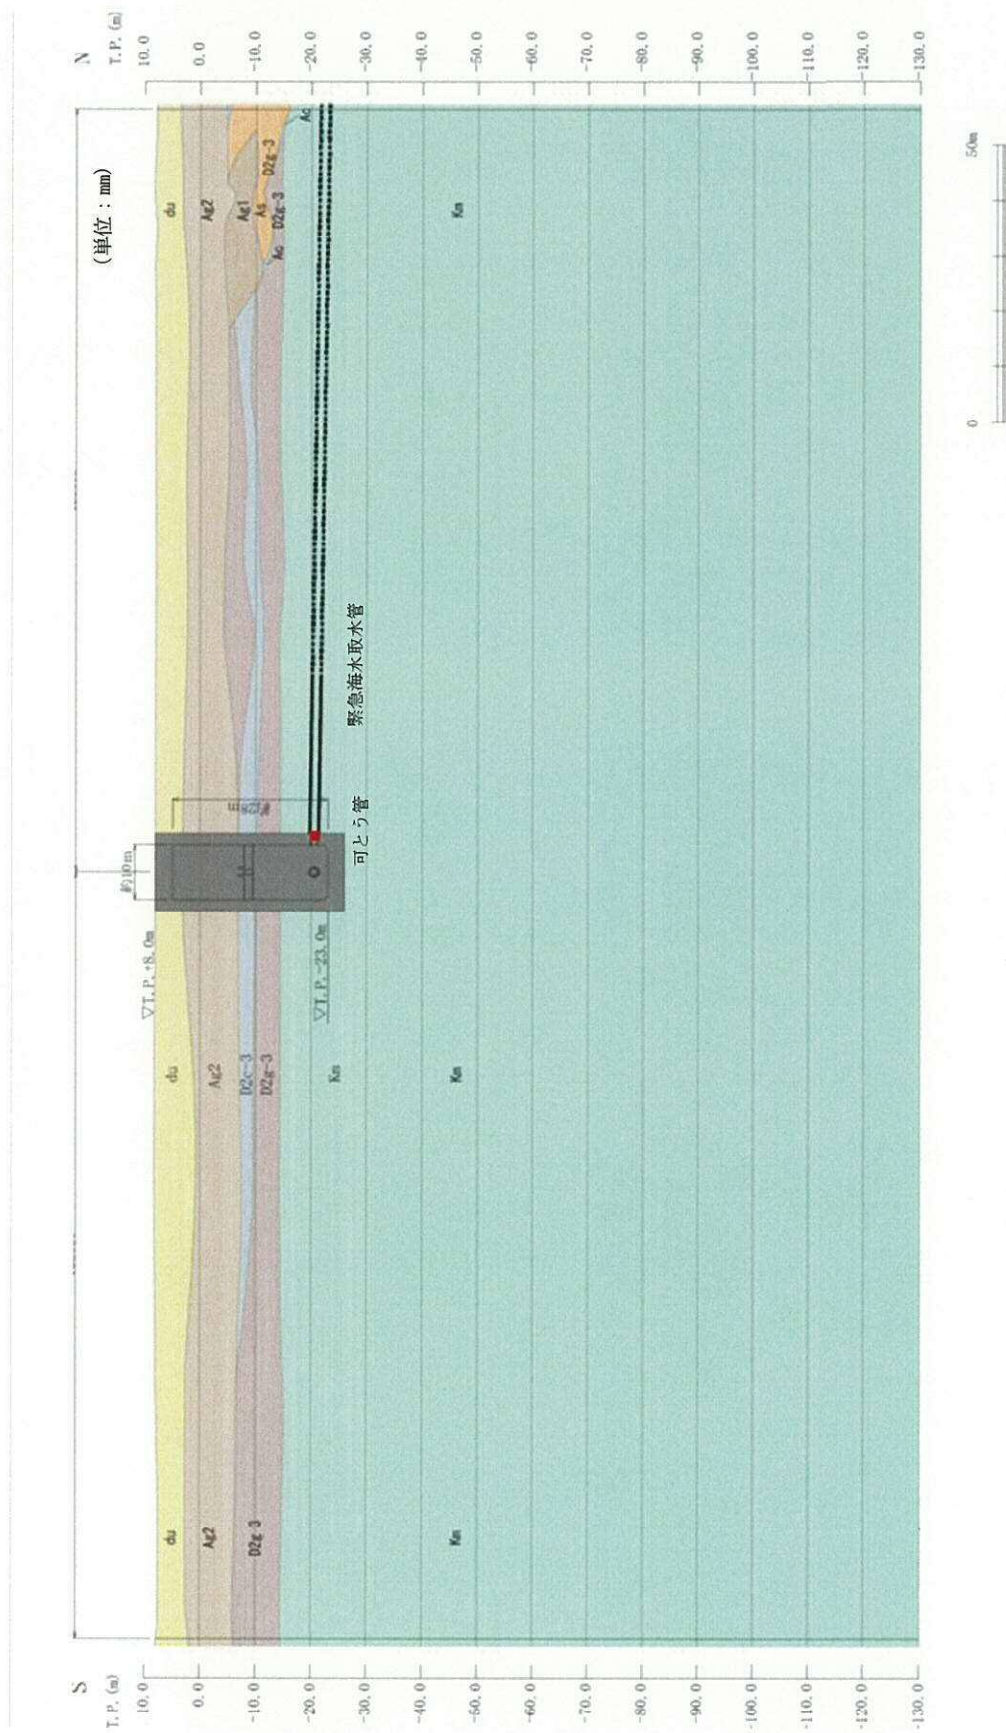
(2) SA用海水ピット評価対象断面 (②-②断面)
